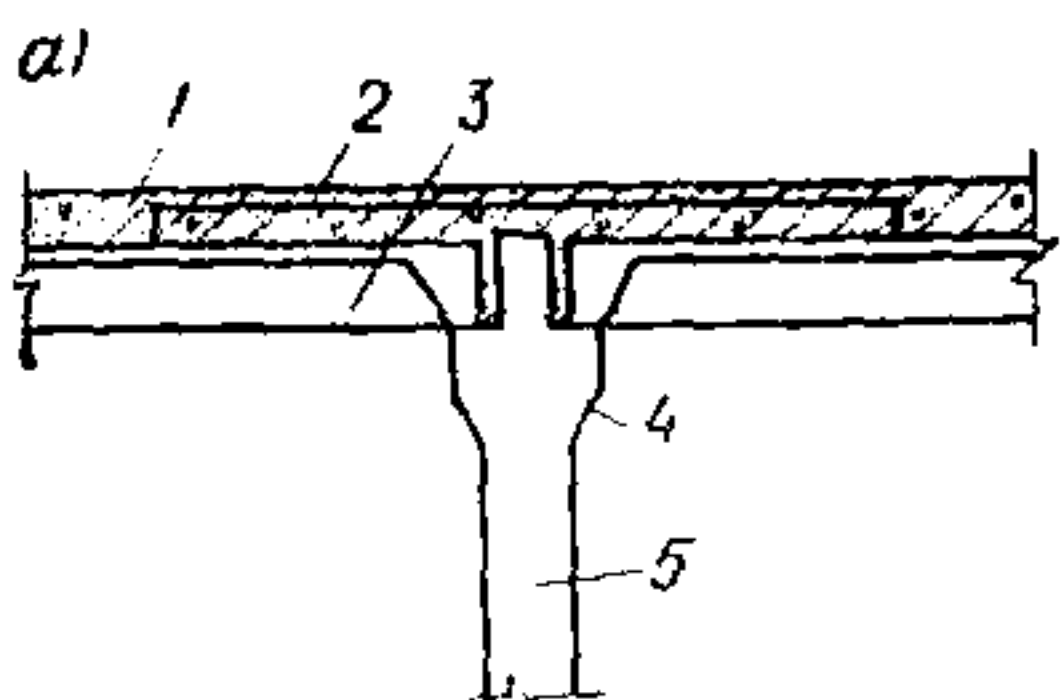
Установка надпорной арматуры в сборно-монолитном перекрытии убежища
